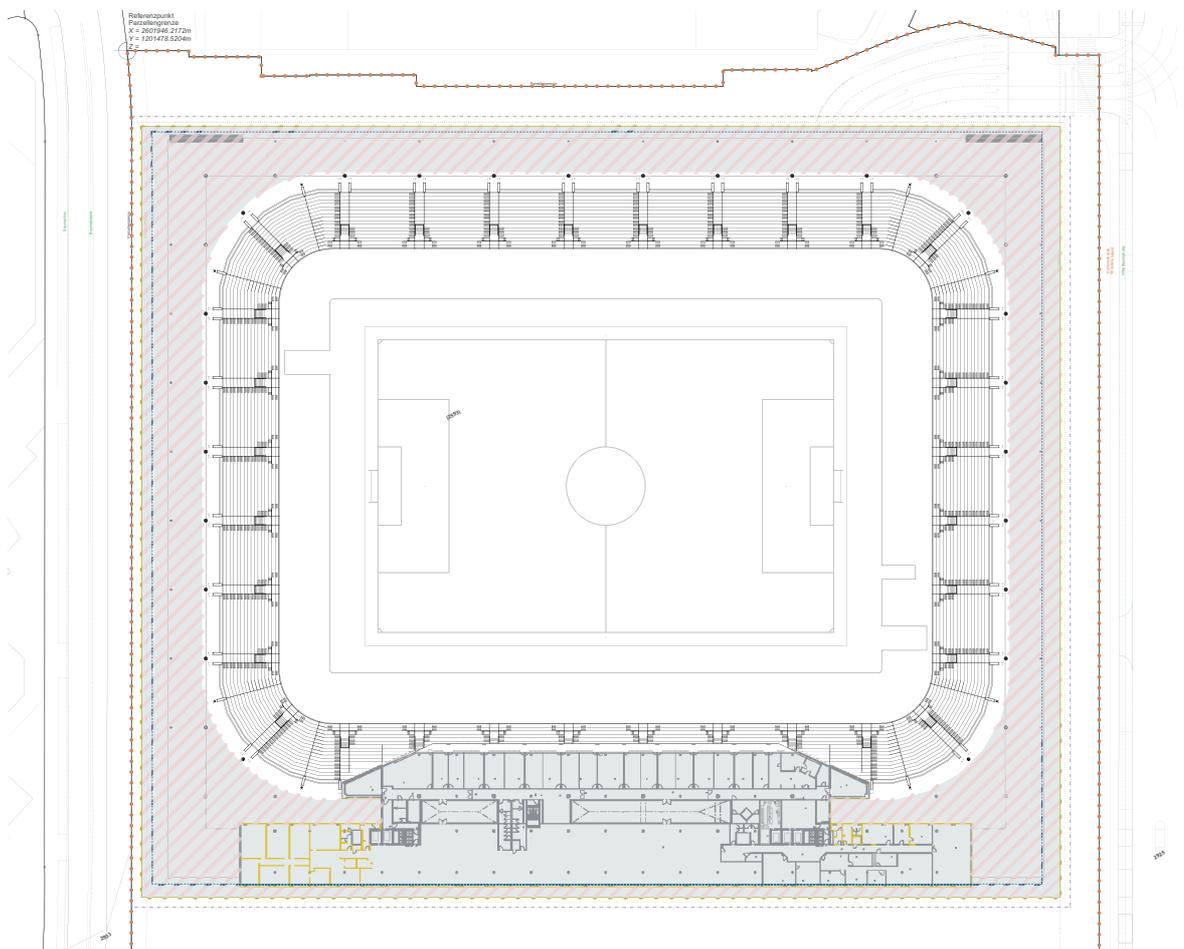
Auszug Machbarkeitsstudie: Schemagrundriss, Quelle: Aebi&Vincent Architekten, Bern
